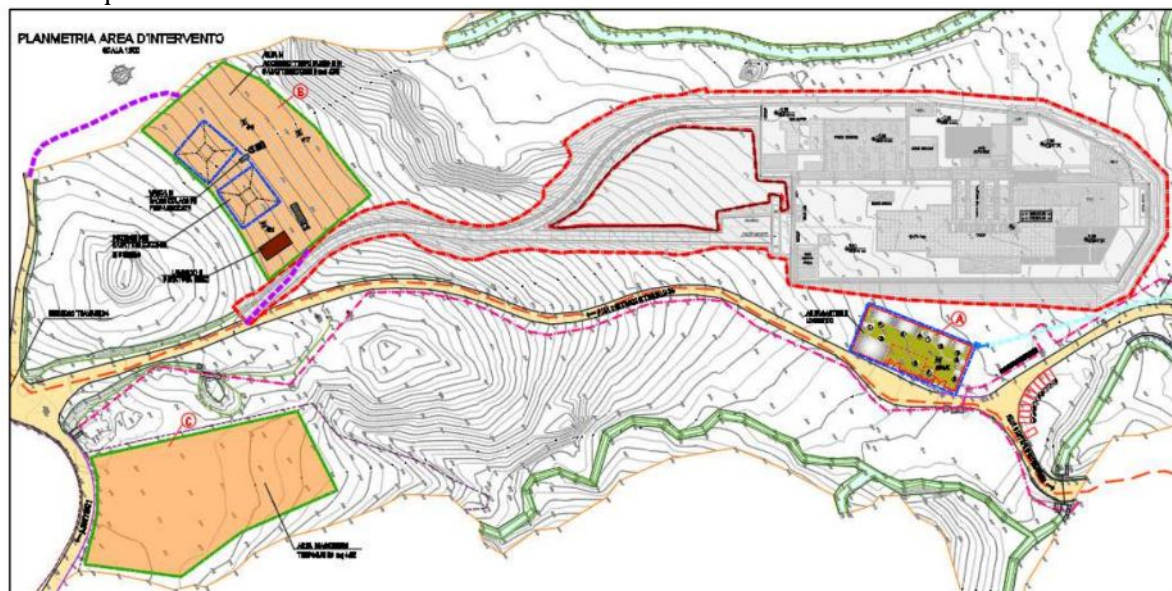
Disposizione delle aree di cantiere ed identificazione delle aree di accumulo temporaneo e di caratterizzazione (Area B) e di accumulo temporaneo in attesa di conferimento (Area C) - Stralcio elaborato di progetto GRE.EEC.D28.IT.G.13405.00.045. Planimetria e pianta cantiere civile.
